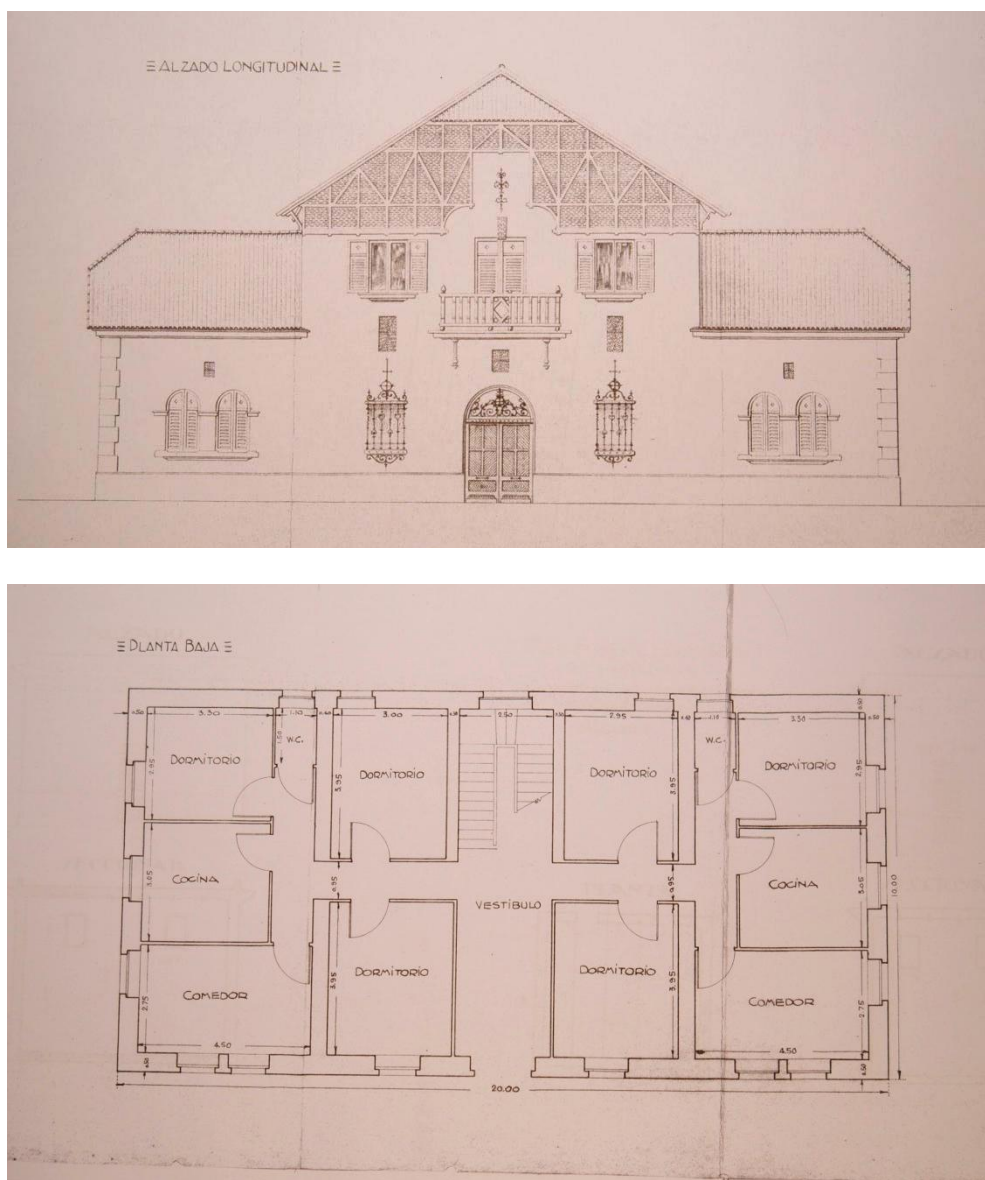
Viviendas para personal para las electrificaciones a 1.500V en Cataluña y País Vasco, alzado y planta (1928). Fuente: AGA
